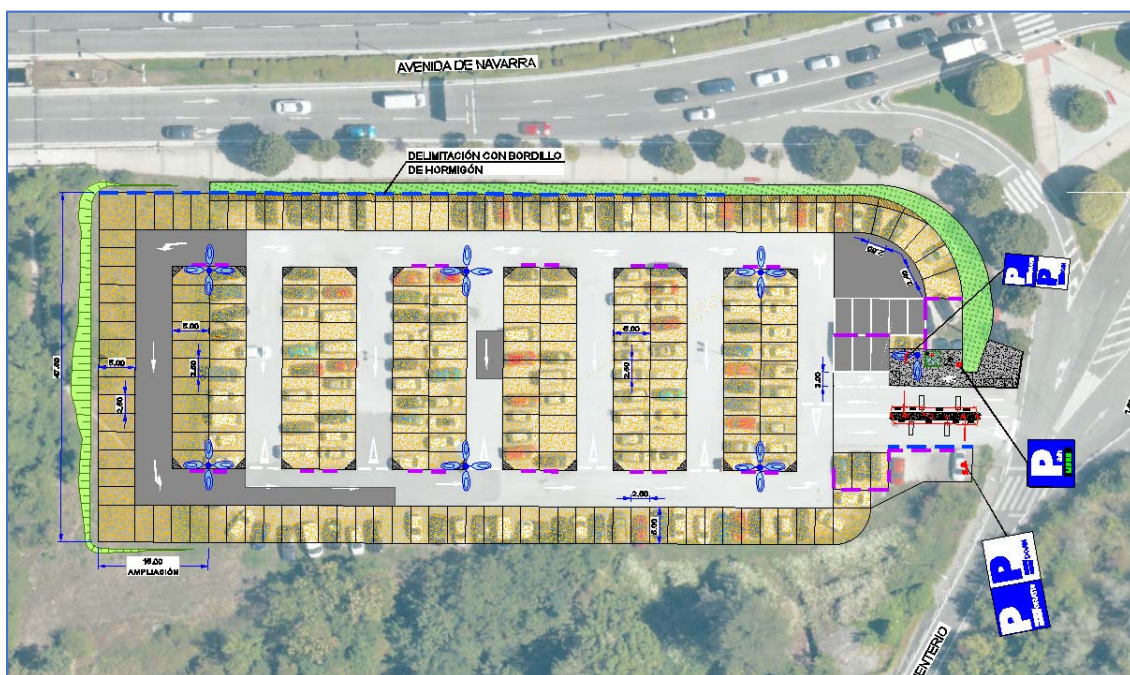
Detalle del plano de planta del estado definitivo del aparcamiento de San Juan..
